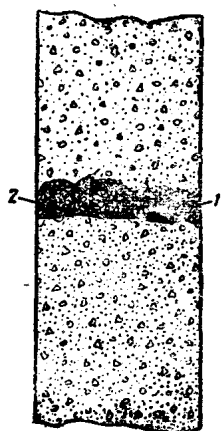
鋼筋混凝土柱由于在灌筑混凝土时落入雪花而形成的裂縫
